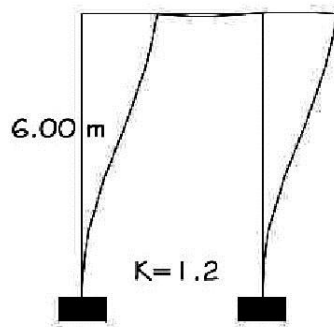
Factor de longitud efectiva K de las columnas en el plano del pórtico
